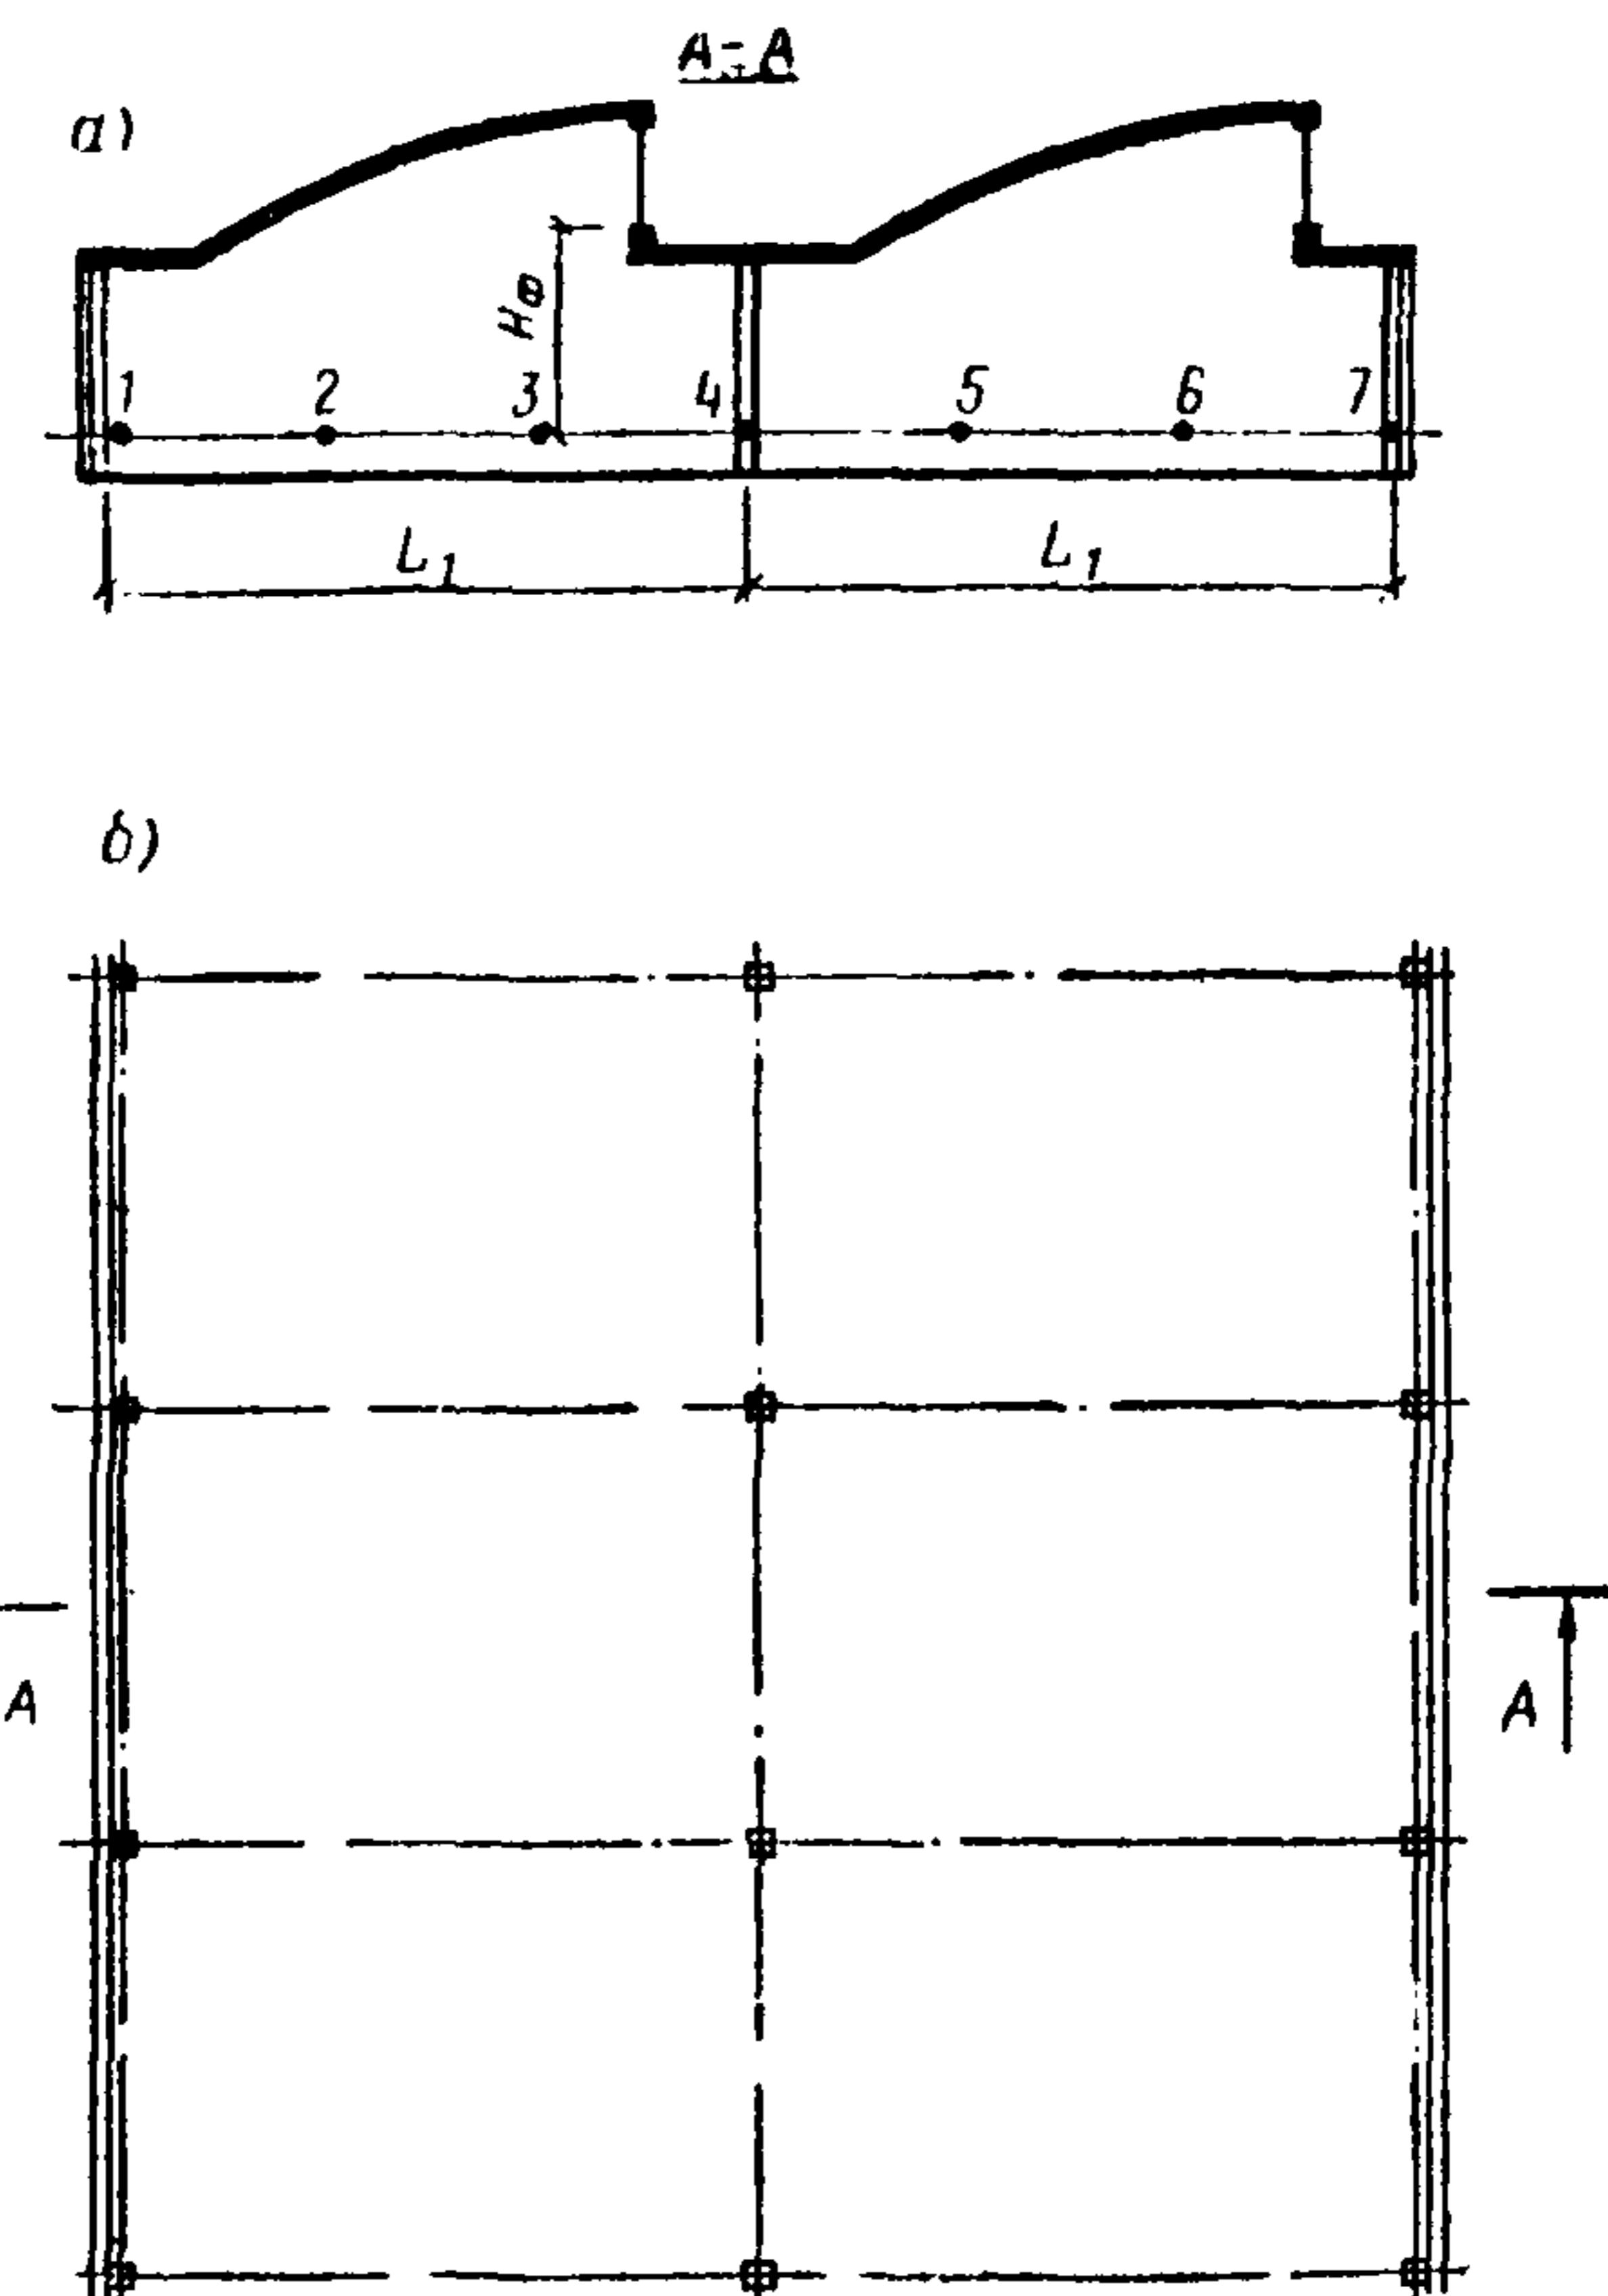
Схематические разрез и план производственного помещения с фонарями шед
